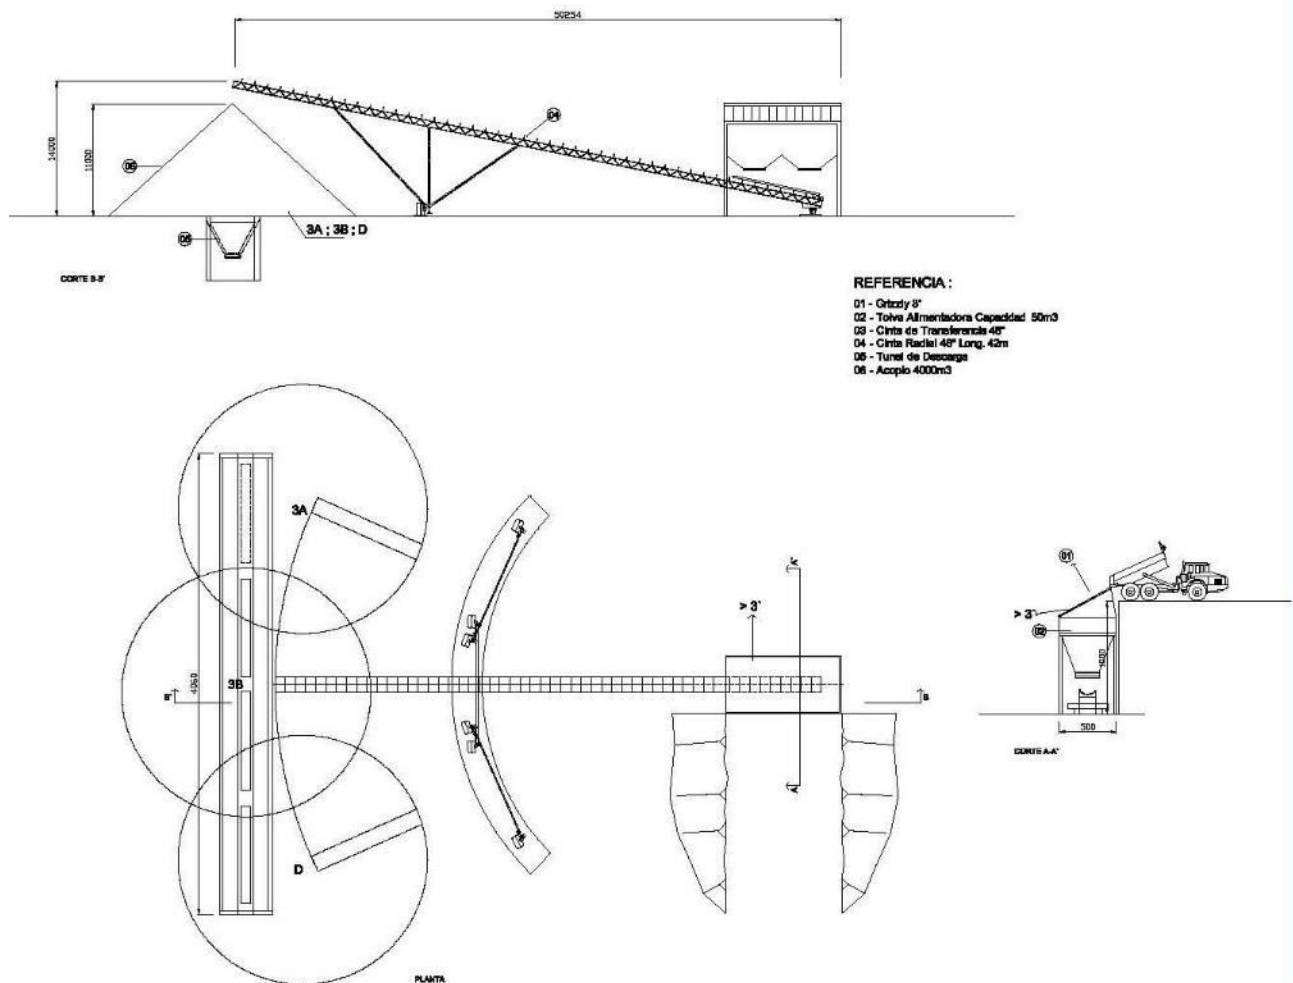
Esquema de planta y vista de Grizzly Fijo.
